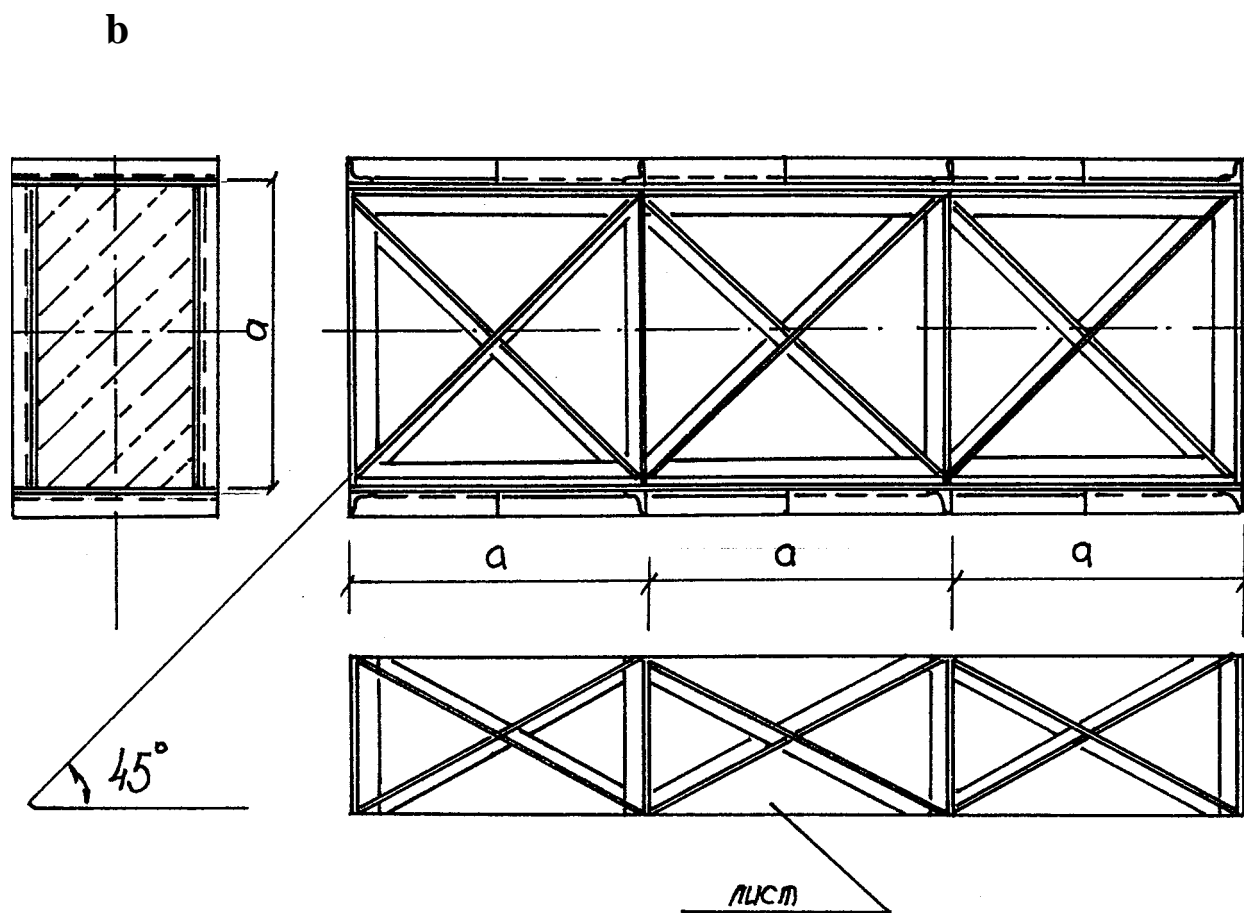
Сталобетонный элемент колонны каркаса тепловой электростанции
